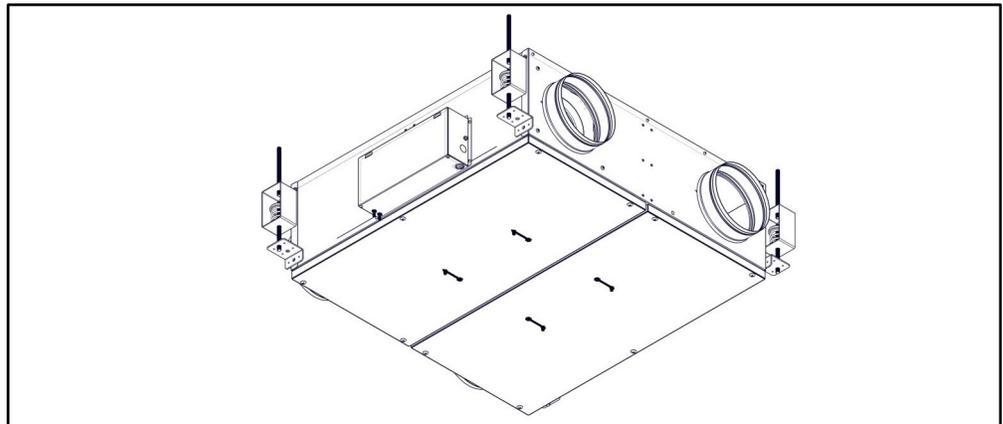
SUSPENSION AU PLAFOND AVEC ISOLATEURS DE VIBRATIONS OPTIONNELS, MONTAGE INFÉRIEUR
